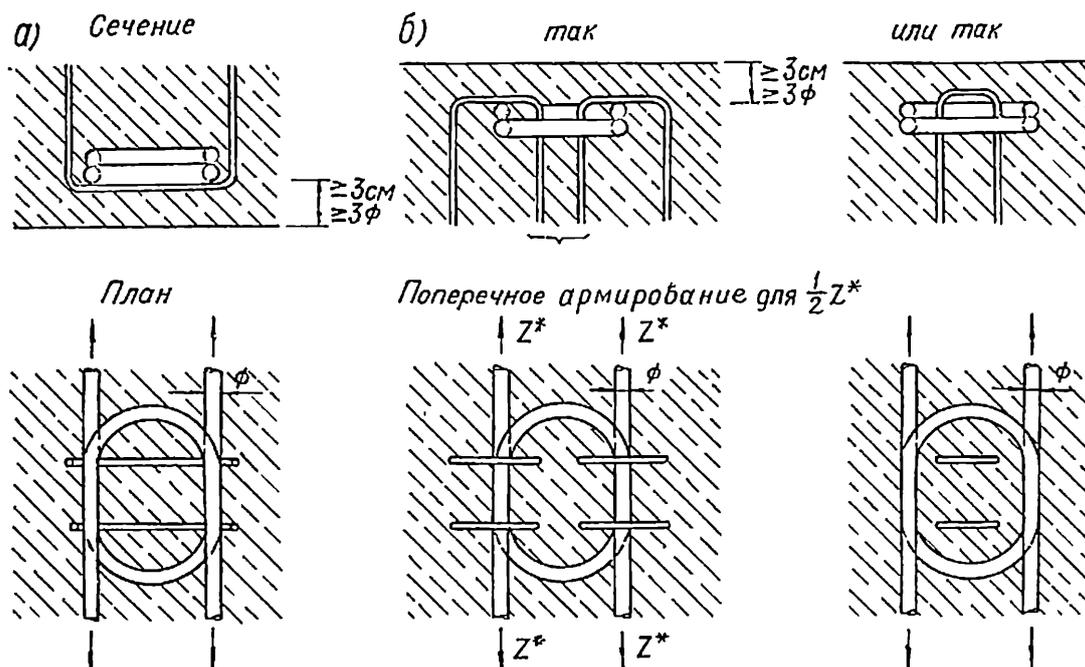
8Б. Страховка стыков внахлестку с петлями с помощью усиленного защитного слоя бетона и поперечной арматуры, например, со шпильками (а) - малое растягивающее усилие, (б) - большое растягивающее усилие
